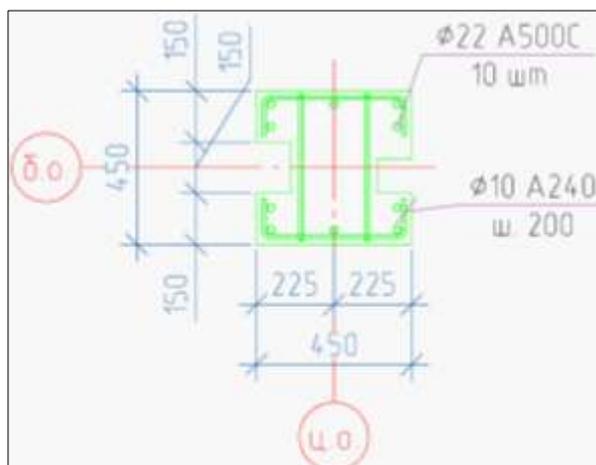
Принципиальная схема армирования колонны двутаврового поперечного сечения, полученная из расчётов
